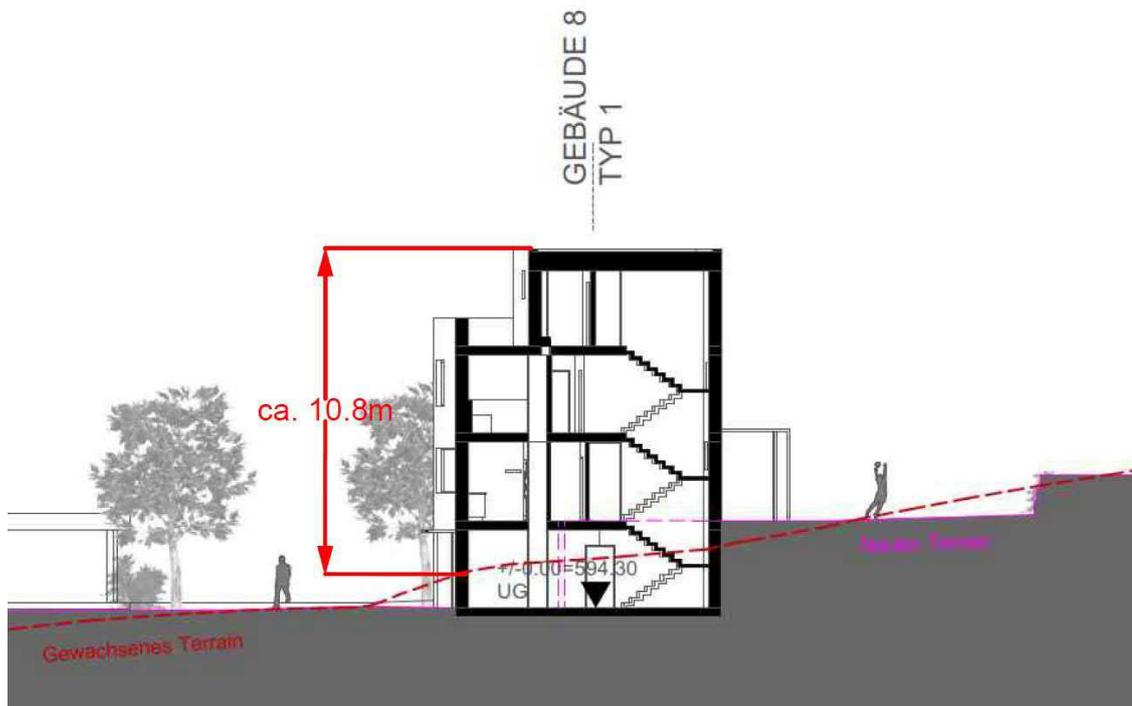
Messweise Gebäudehöhe (oberstes Geschoss zurückversetzt)
